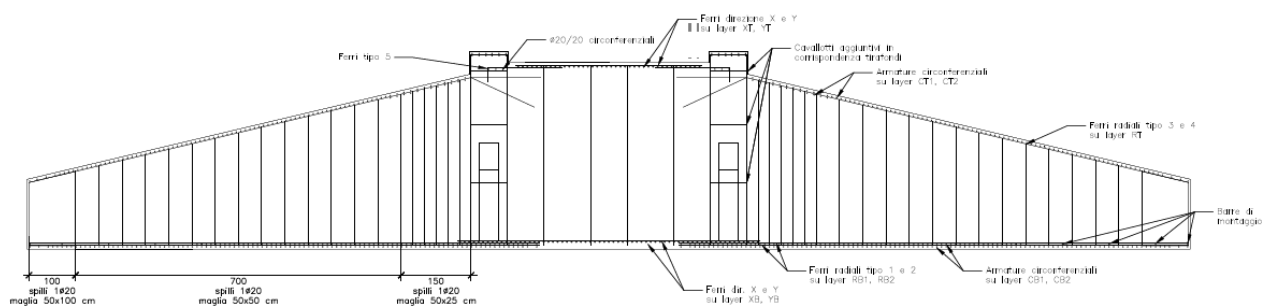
Sezione plinto di fondazione - identificazione armatura
